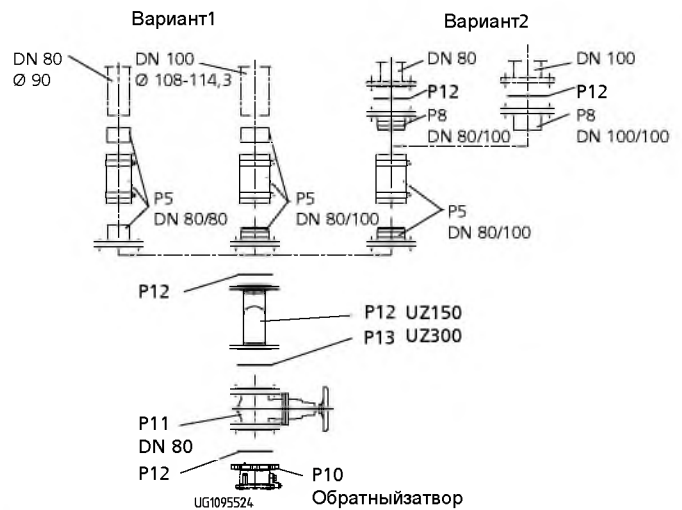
Присоединения типоразмеров U100, U300, UZ150, UZ300¹¹¹⁾
